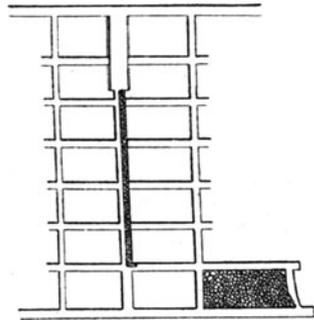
Bremsbergherstellung und Breitauffahren einer Grundstrecke bei steiler Lagerung.
